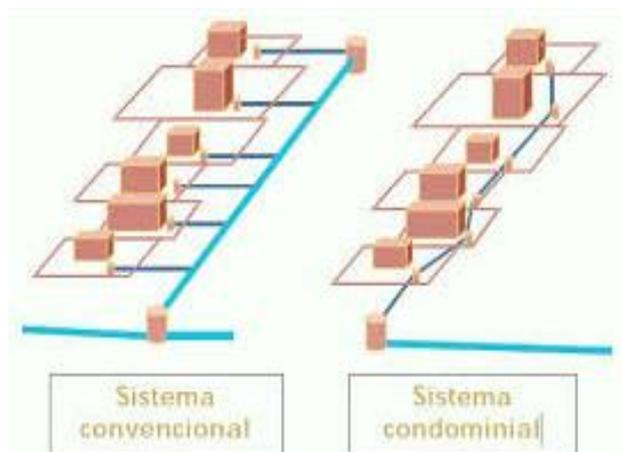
Sistema Alcantarillado pluvial. Fuente: Libro de alcantarillado.
